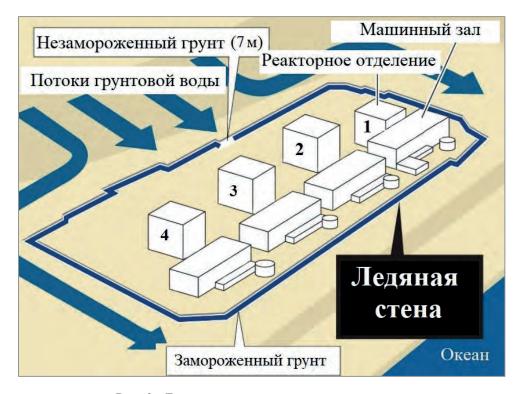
«Ледяная стена», защищающая площадку с блоками от попадания грунтовых вод
